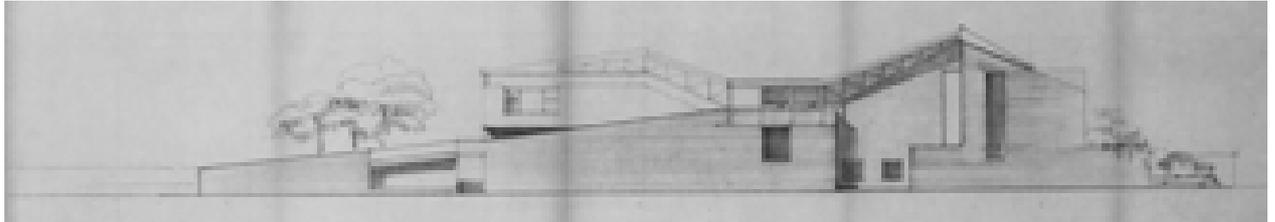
Prospetto Nord, stato futuro – 15/01/1977 (AABS-1996.699)
